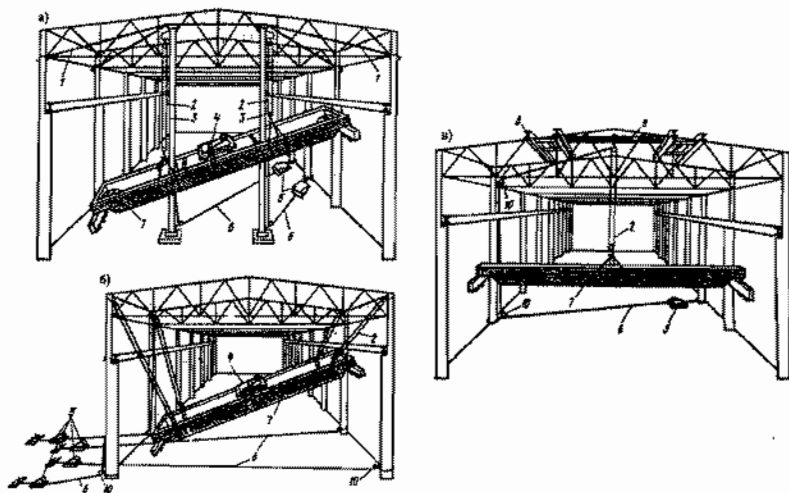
Схемы монтажа мостового крана в здании насосной станции: 1 - венты; 2 - грузоподъемные полиспасты; 3 - монтажные мачты; 4 - грузоподъемная тележка крана; 5 - лебедки; 6 - сбегающие нити полиспастов; 7 - мост крана; 8 - вспомогательные балки; 9 - монтажная балка; 10 - отводные блоки
